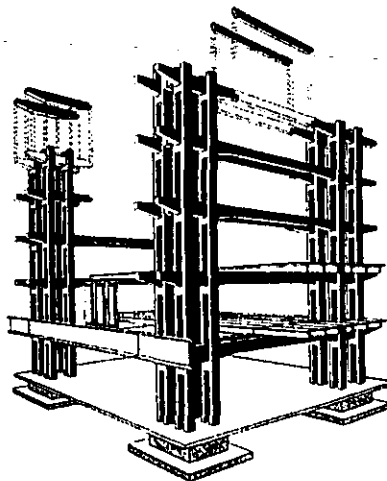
Sistema a base de elementos prefabricados desarrollado por Riobón
